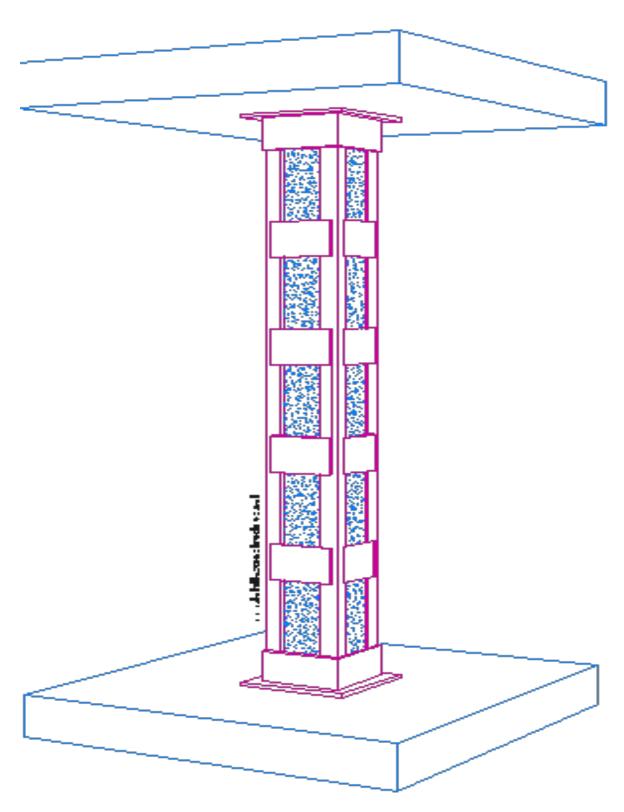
Encamisado de columna con perfiles angulares de acero (Fuente: detallesconstructivos.net)
